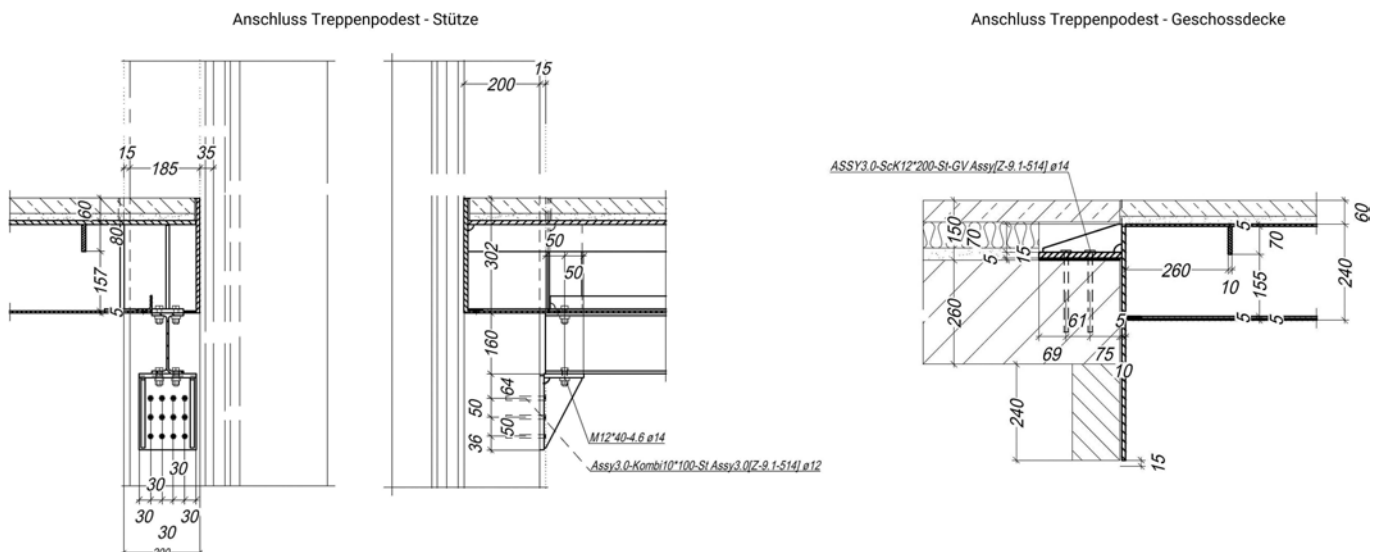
Anschlusspunkte Treppenkonstruktion (Quelle: StahlbauFrank)
